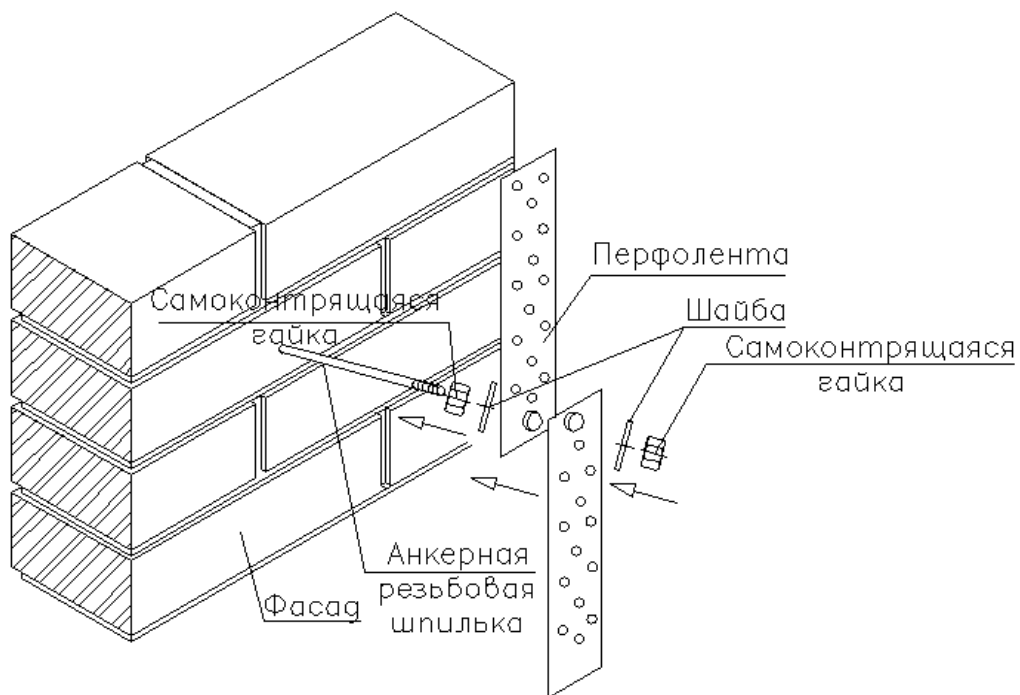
Крепление перфоленты к анкерной резьбовой шпильке
